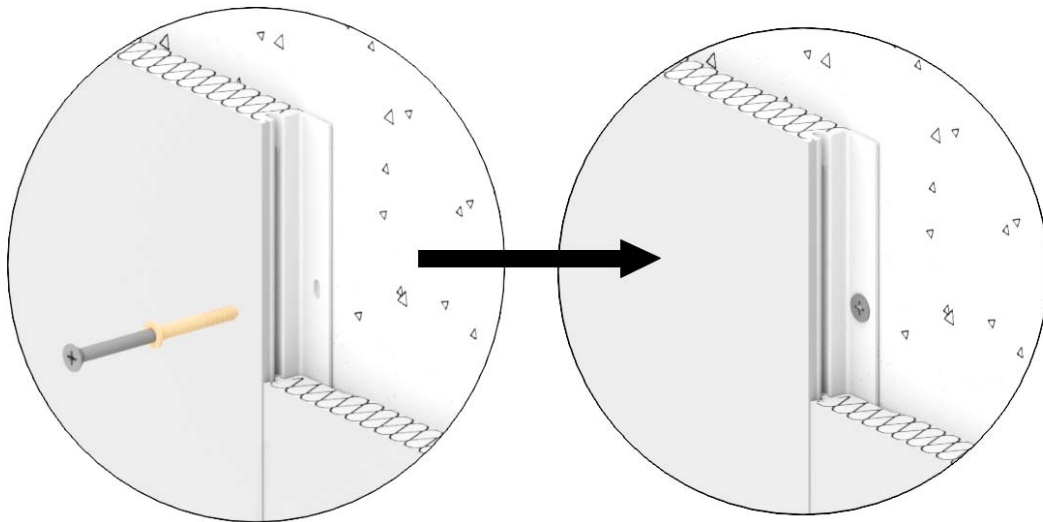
Principe d'emboîtement et fixation cachée des panneaux MYRAL
